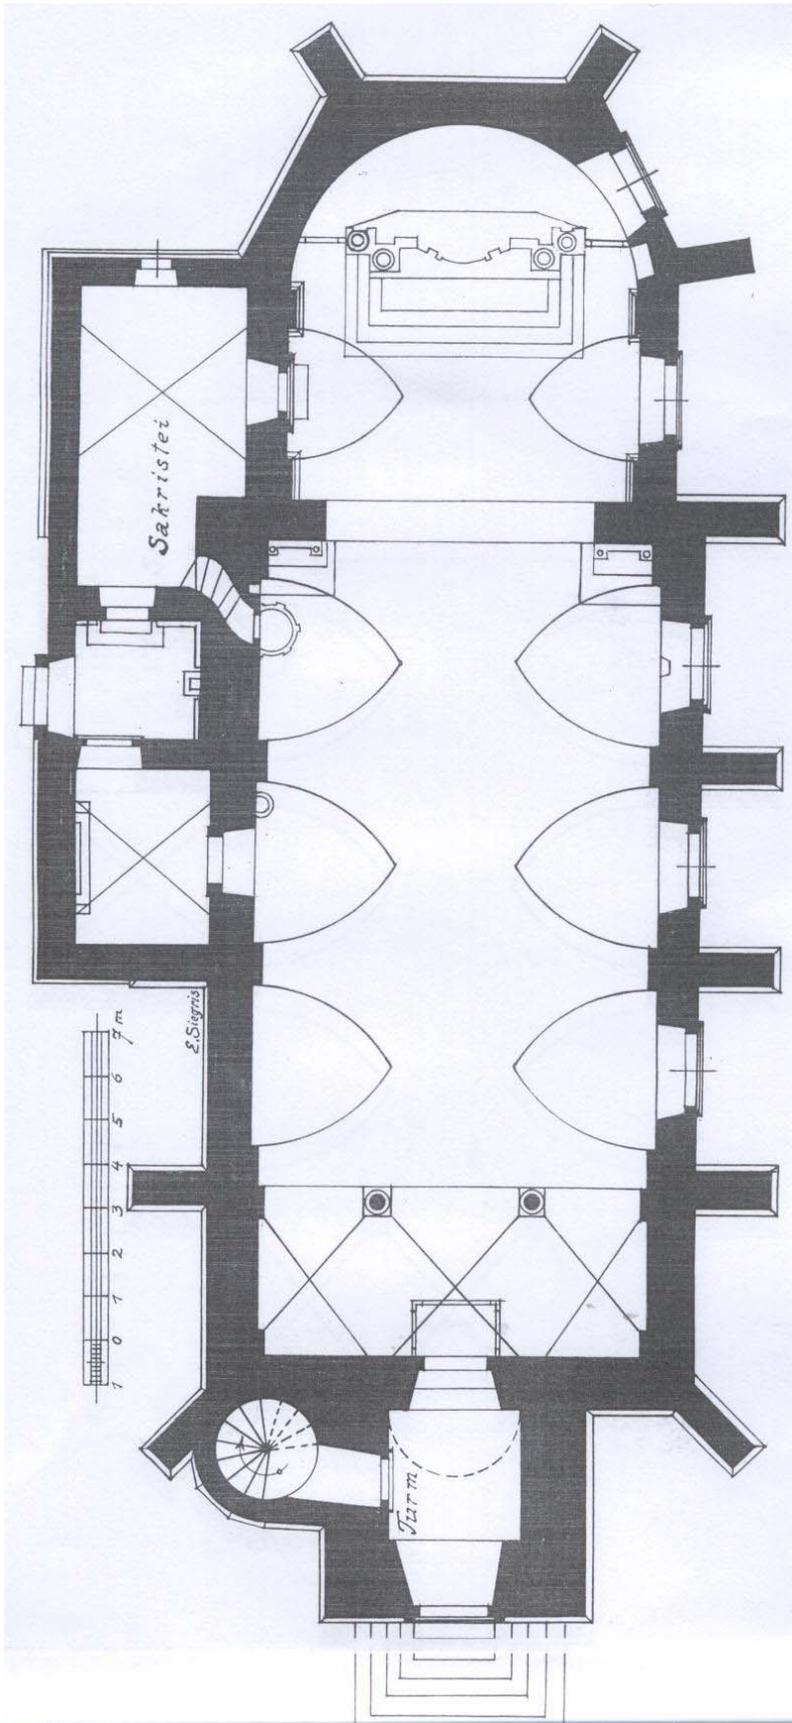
, Grundriss 2, Siegendorf, Pfarrkirche³²²
